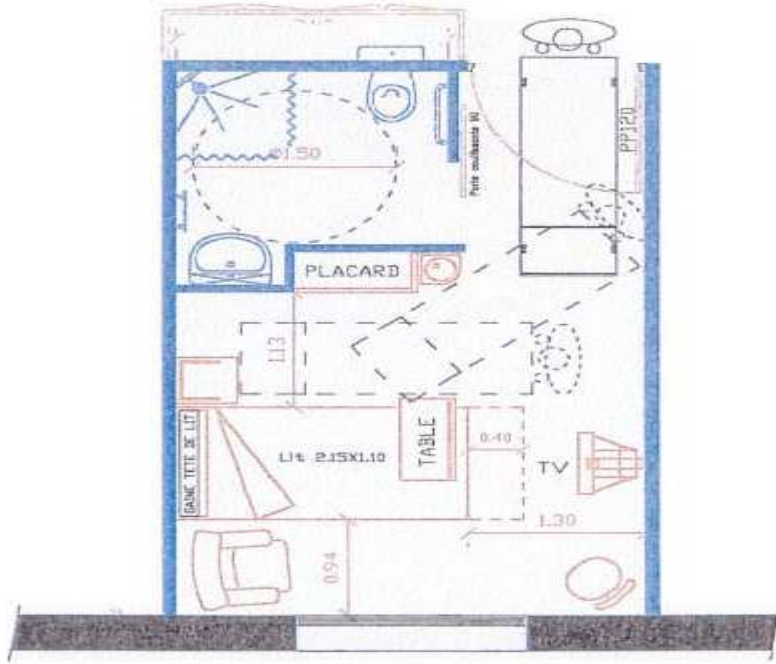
Schéma en construction Plan schématique d'une chambre 1ère variante
